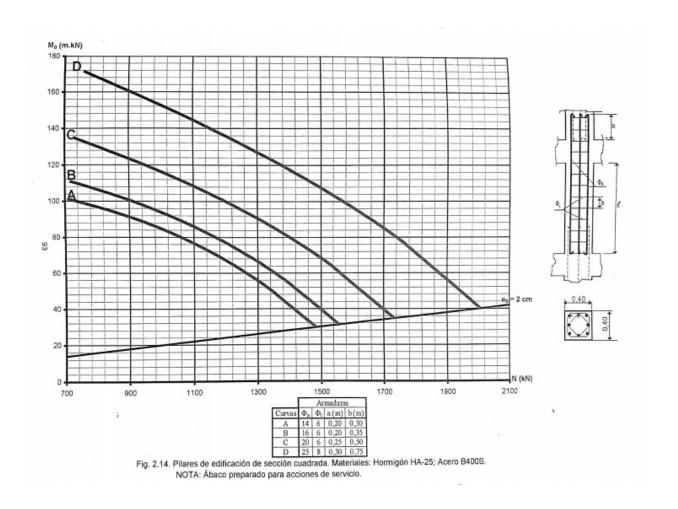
Gráfica para pilares de sección cuadrada de 40x40 cm
